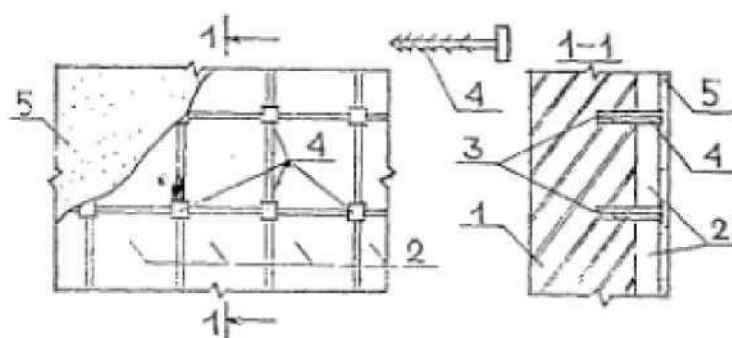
Усиление кирпичных стен: 1- усиливаемая кирпичная стена; сборные плиты обоймы (железобетонные, керамзитобетонный и др.), устанавливаемые на растворе на подготовленную поверхность стены; 3- деревянные пробки, установленные в просверленные отверстия; 4-анкерные связи, забитые в пробки; 5-штукатурка.
